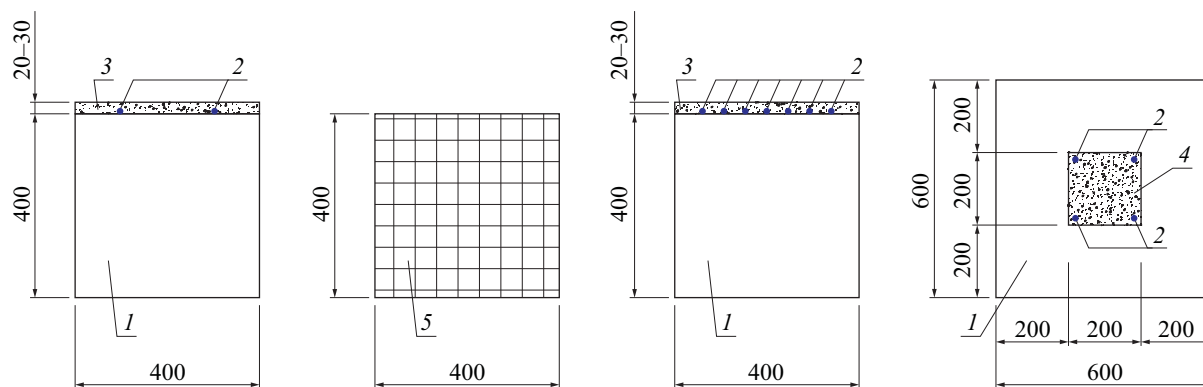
Схема армирования образцов, опыты А.Г. Фигарова: 1 — каменная кладка; 2 — продольная арматура; 3 — раствор; 4 — бетон; 5 — кладка с поперечным армированием [22, 23]
